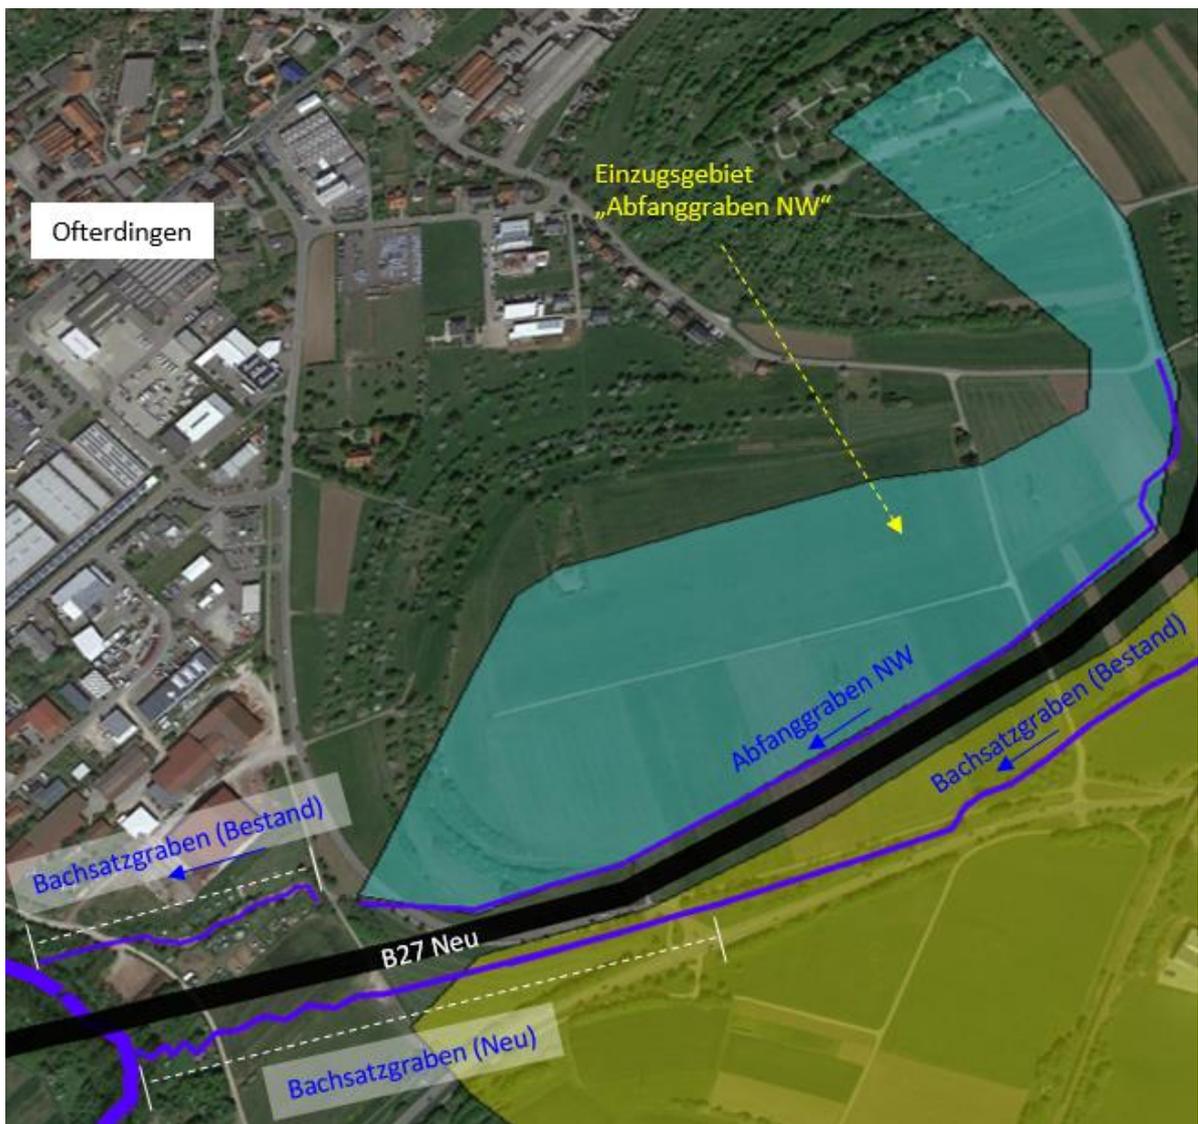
Lageplan zum neu geplanten „Abfanggraben NW“,
